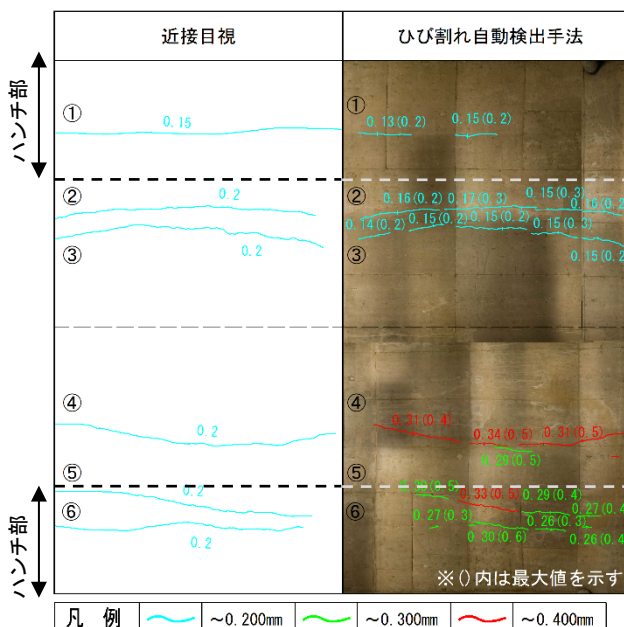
近接目視点検と自動検出手法で確認されたひび割れ状況
